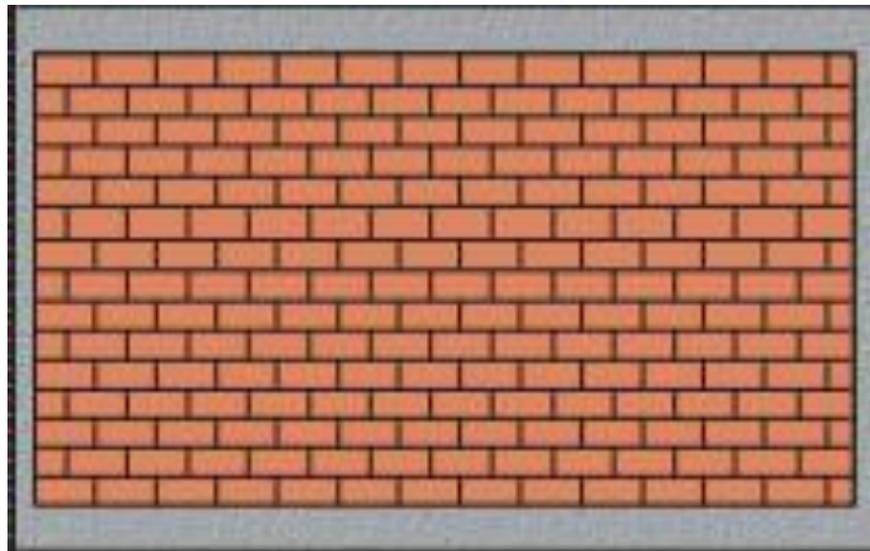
Muro de Albañilería – Fuente: Vallarino (2012)¹⁴
